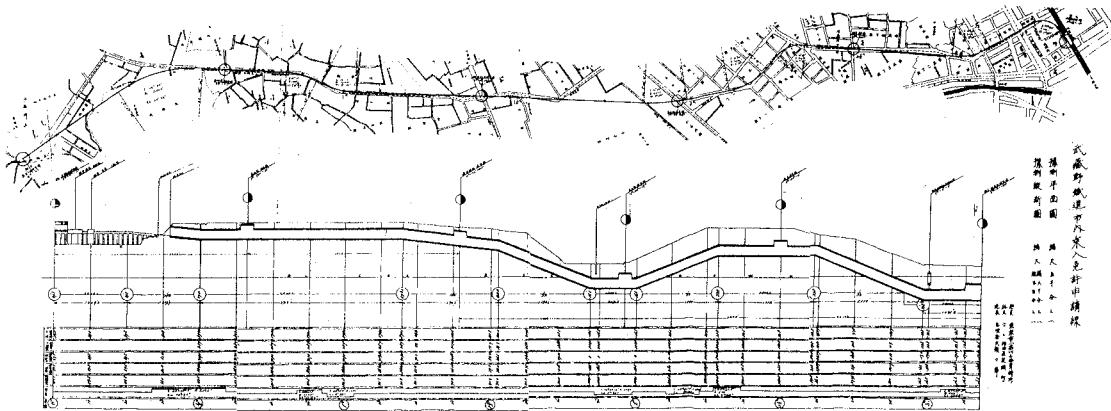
秋葉原延長線の平面図（上）と縦断面図（下）（右側が秋葉原方、左側が護国寺方）
